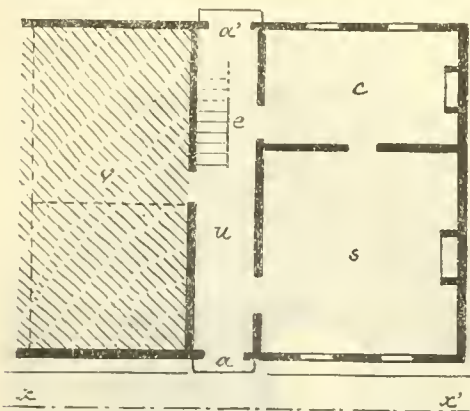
Plan d'une autre petite habitation rurale des Ardennes.
